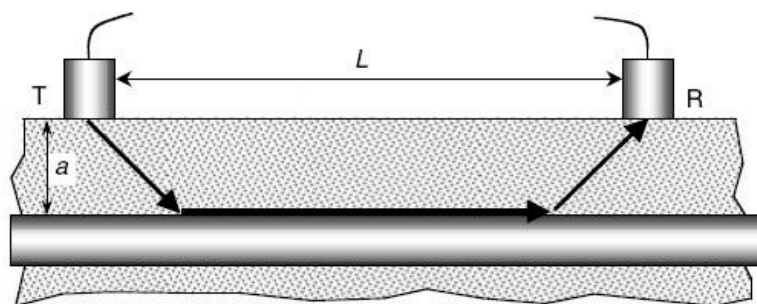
Leitura de ultra-som em betão armado – barras paralelas à direcção de propagação [Rilem, 1972]
